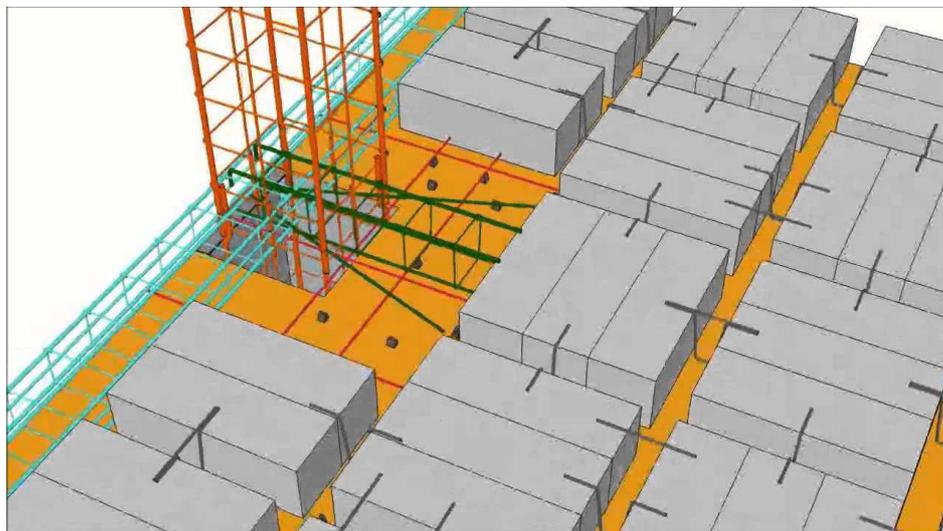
Detalle de losa de hormigón armado (BIBLIOCAD, 2011)
